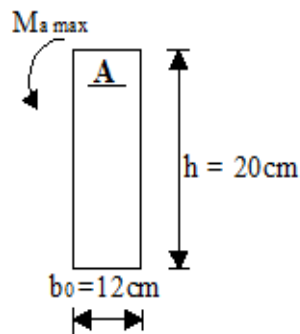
Coupe schématique de la poutrelle (appuis)
